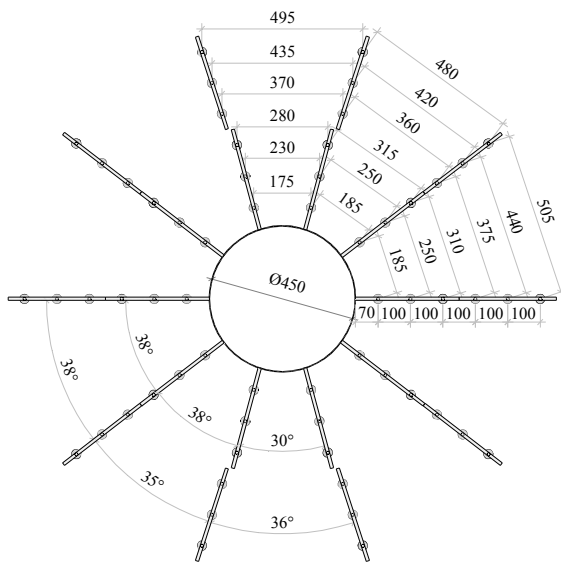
Detalhe das armaduras de cisalhamento da laje LC01
